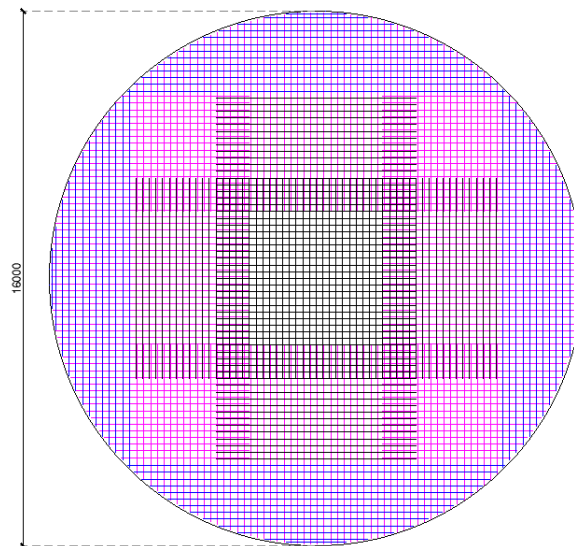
Posicionamiento de varillas longitudinales y verticales
